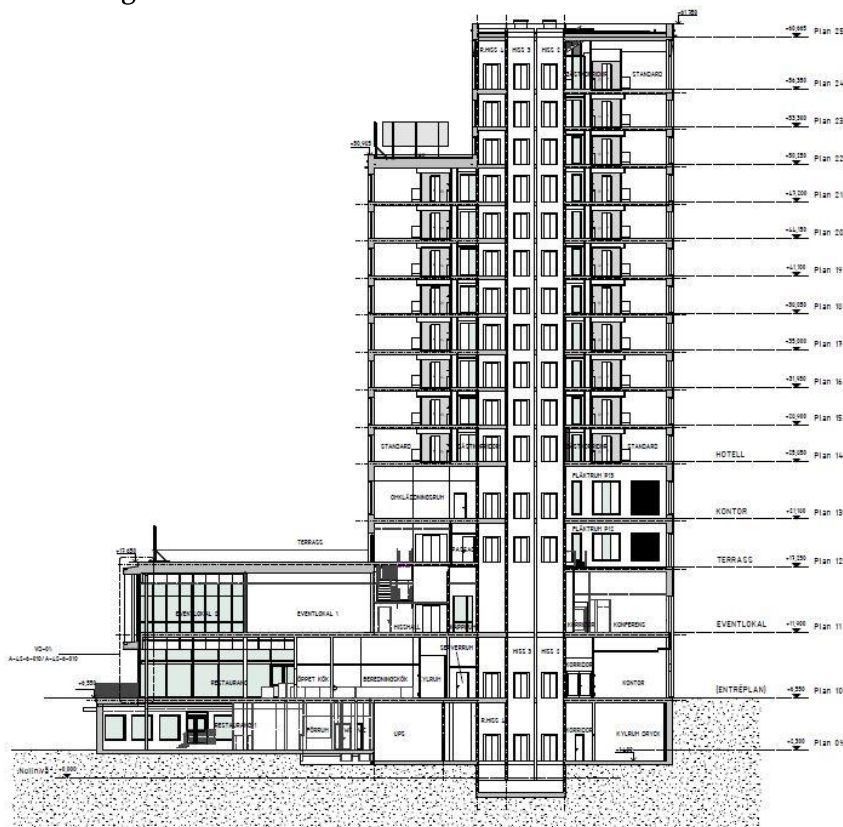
Sektion som visar nivåskillnad mellan Ekdalsgatan (Plan 01) och Marenplan (plan 02), Fojab
